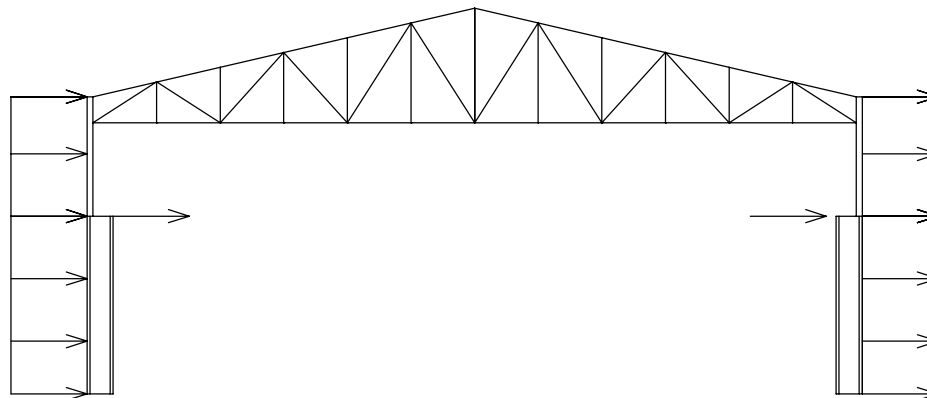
Pórtico transversal sob ação das forças horizontais da ponte e do vento.
